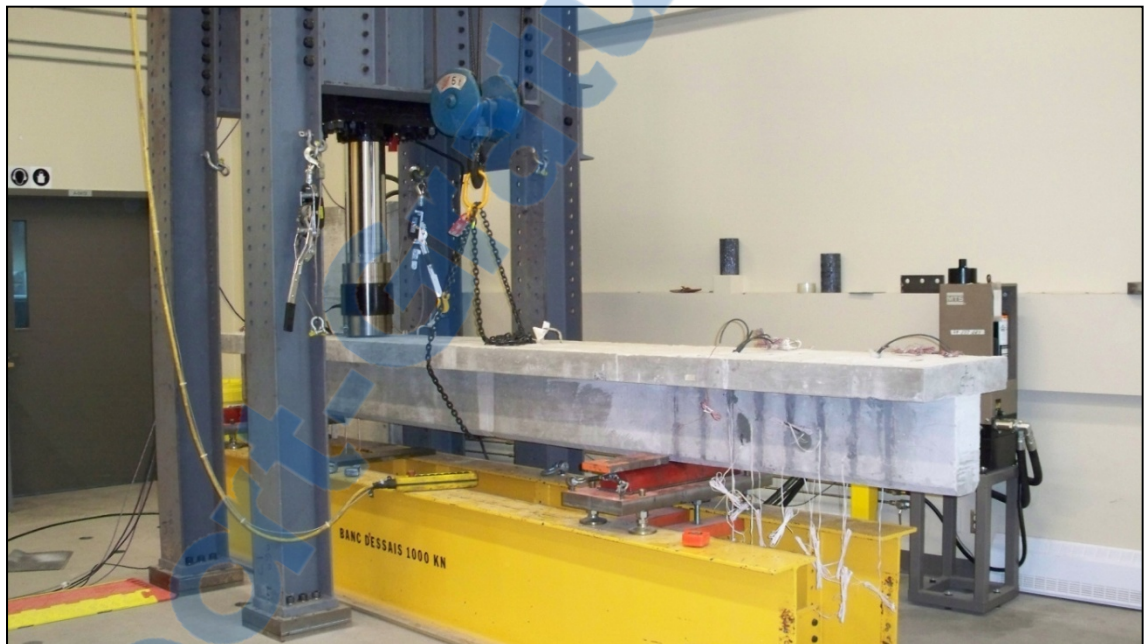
Banc d'essais (vérin en position de chargement)
